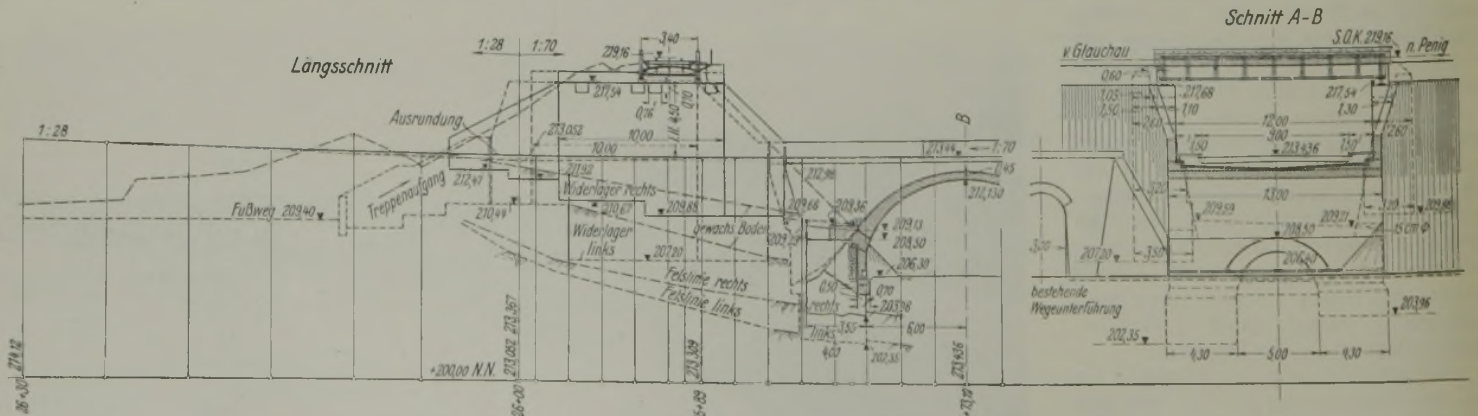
Querschnitt und Längsschnitt der Eisenbahnüberführung.
